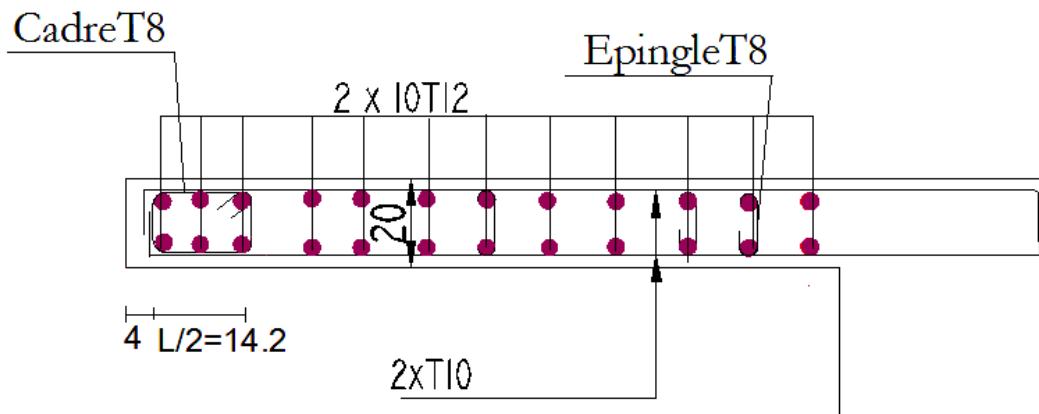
Exemple de ferrailage du voile V_{y2} (e=20cm)
